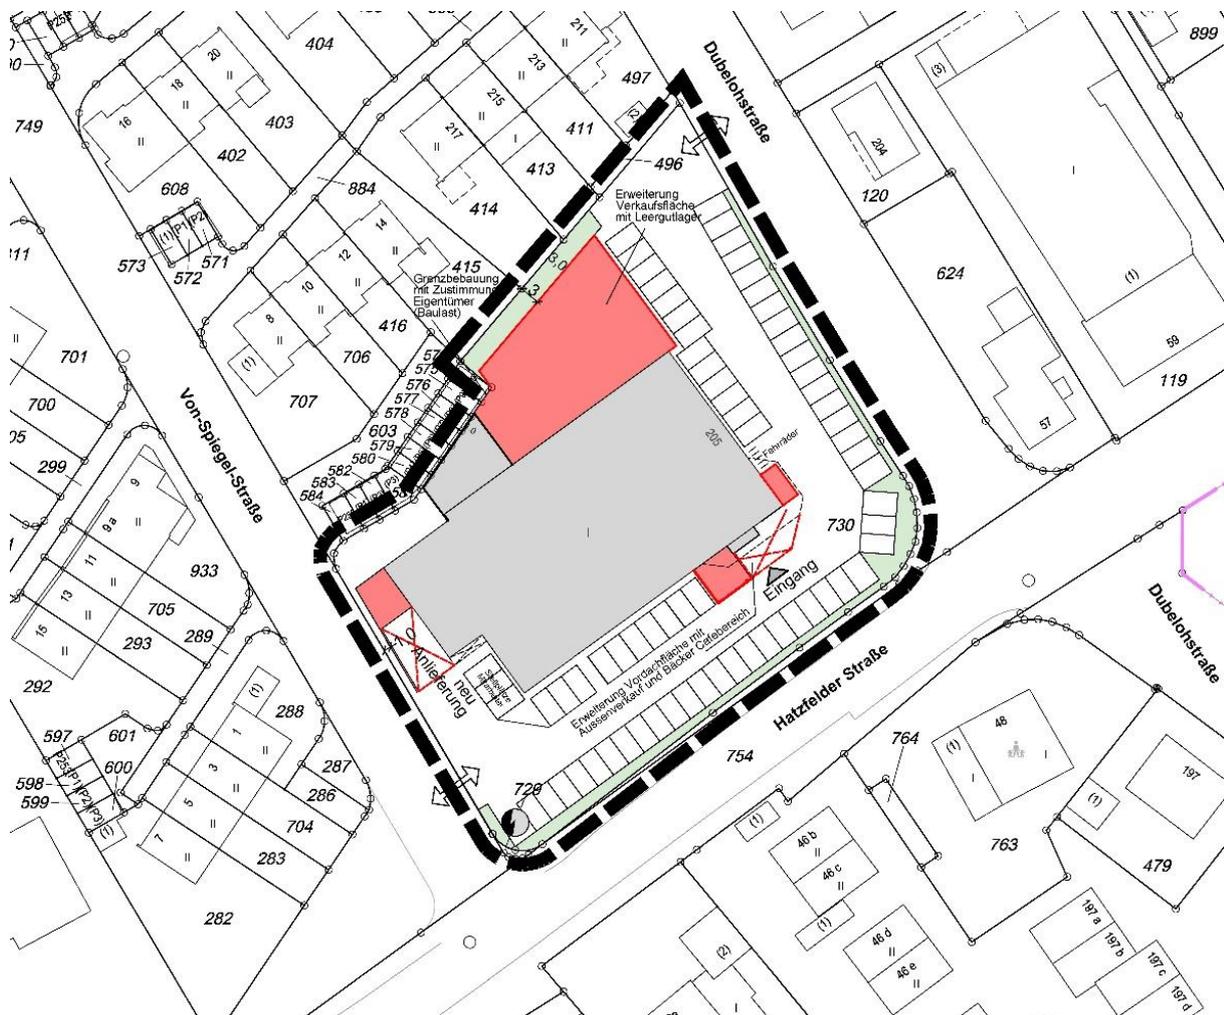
Lageplan / Vorhaben- und Erschließungsplan, o. M. (Quelle: Körber & Möllenbrok, Blomberg, Juni 2022)
